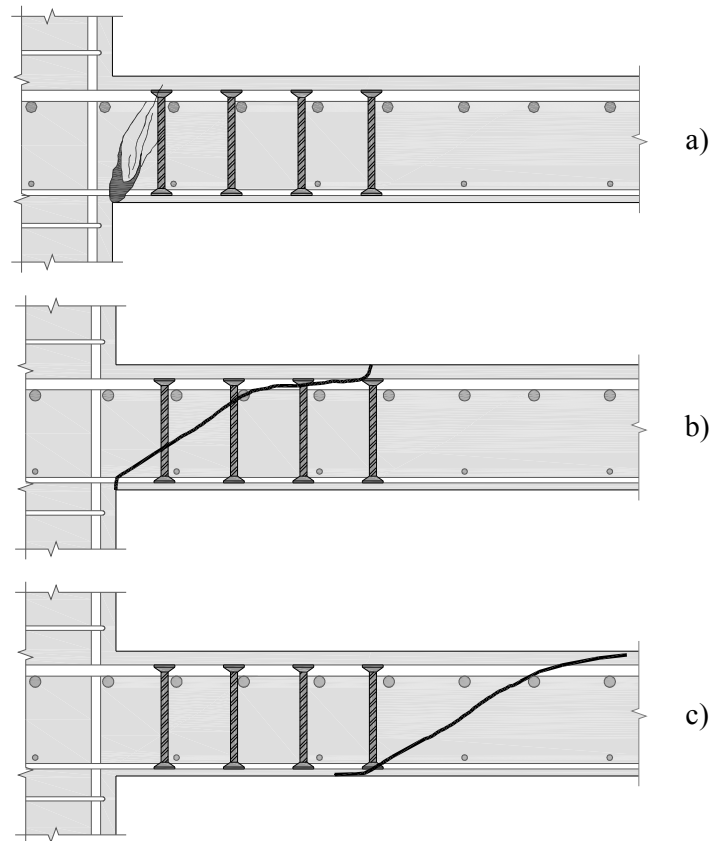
Tipos de ruptura por punção em lajes com armadura de cisalhamento
